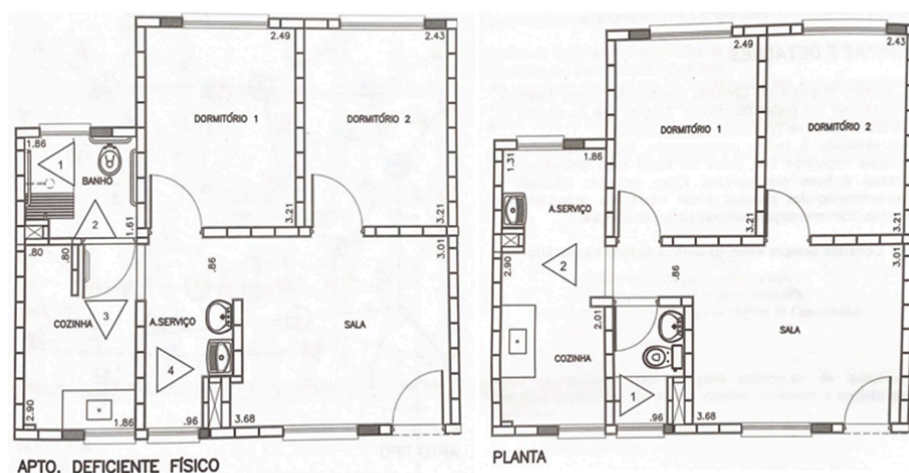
Planta baixa dos pavimentos inferiores e superiores
